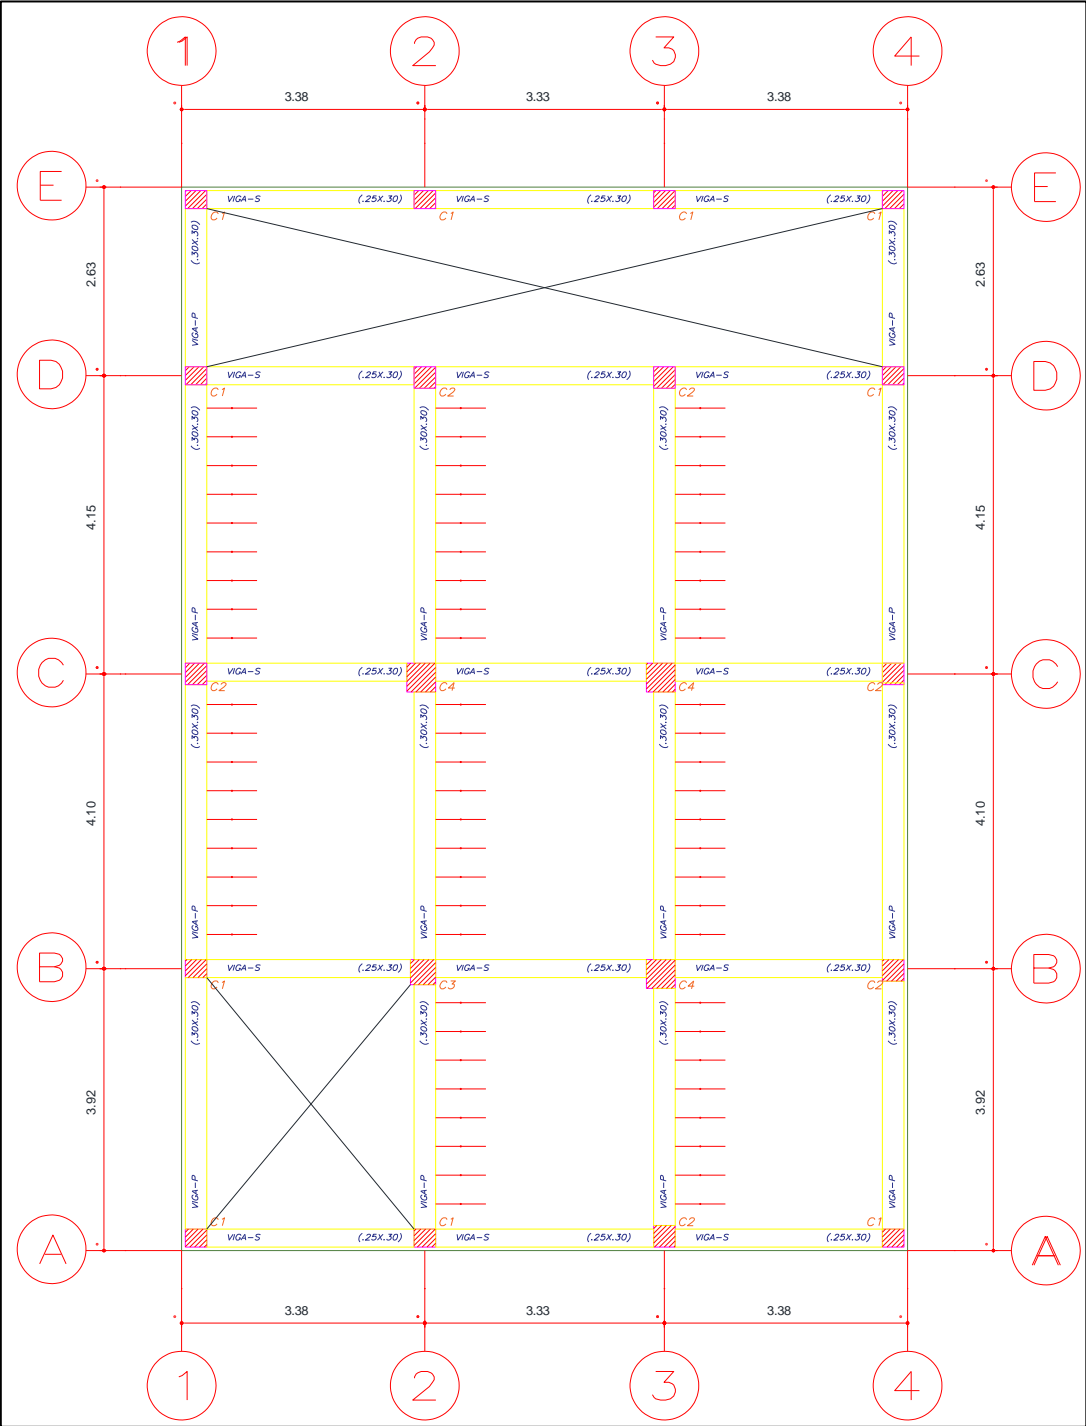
Plano con Vigas y Columnas Predimensionadas
